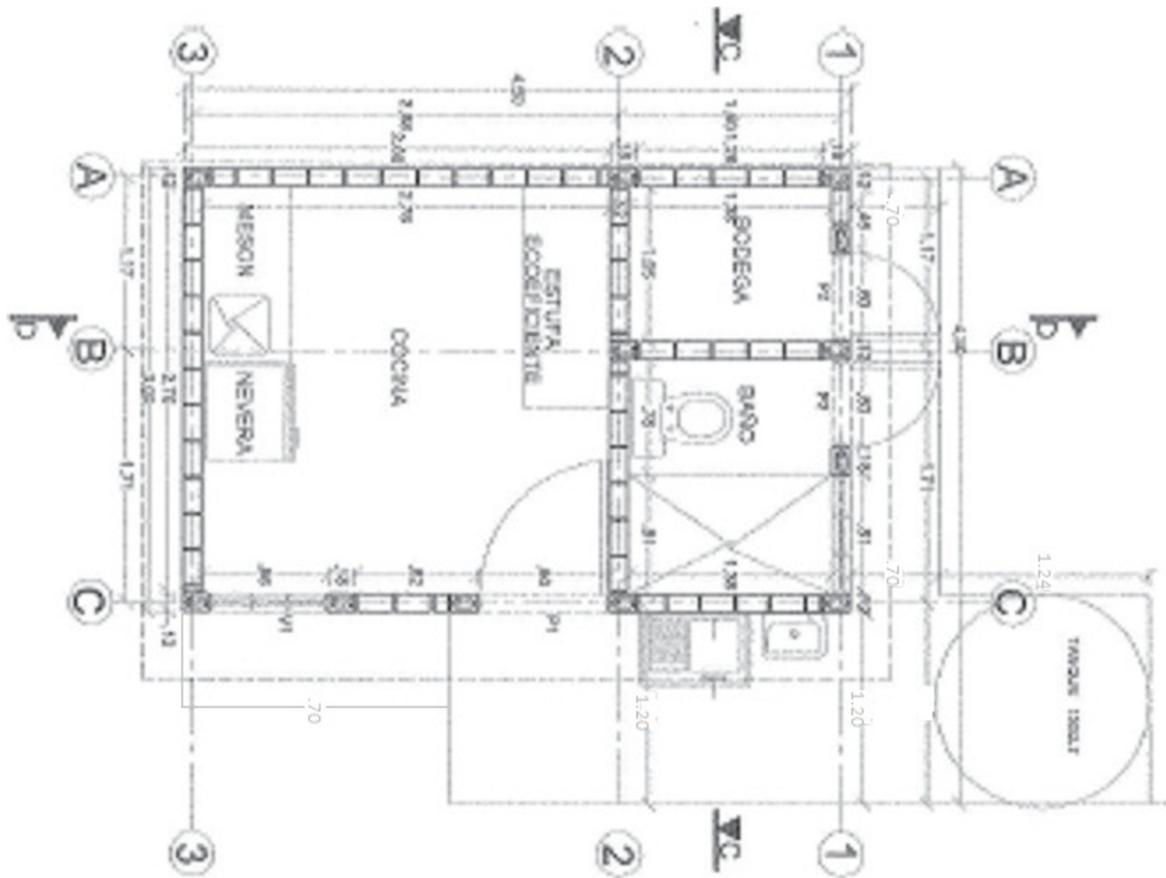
Plano planta arquitectónica MVSB Municipio de Totoró. Fuente: Comfacauca
